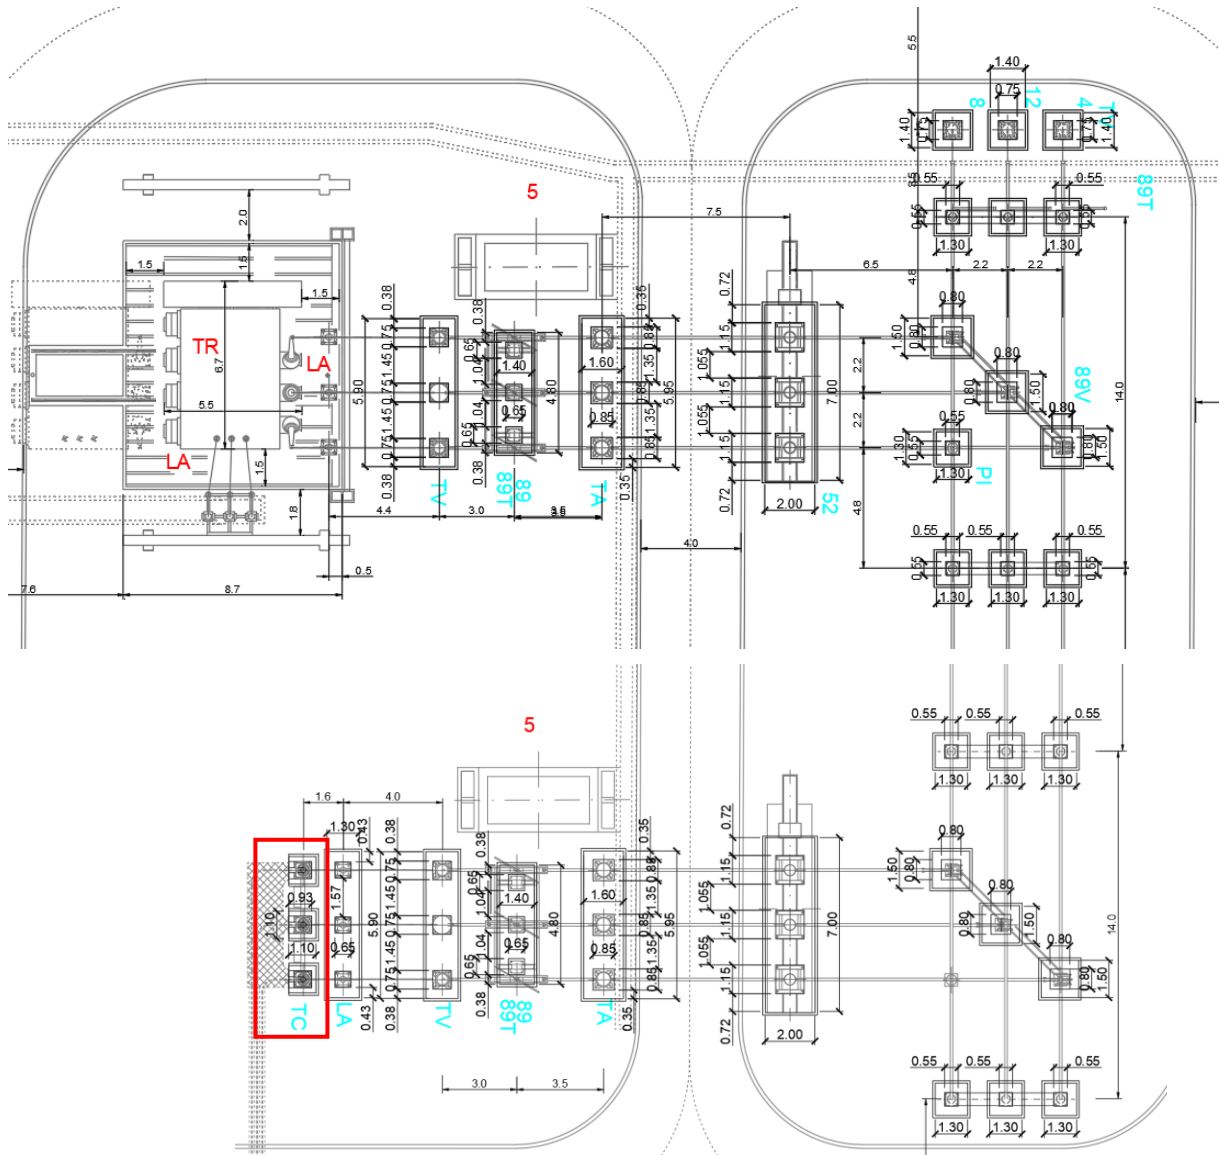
Planimetria degli elementi della sottostazione utente (Nord)
